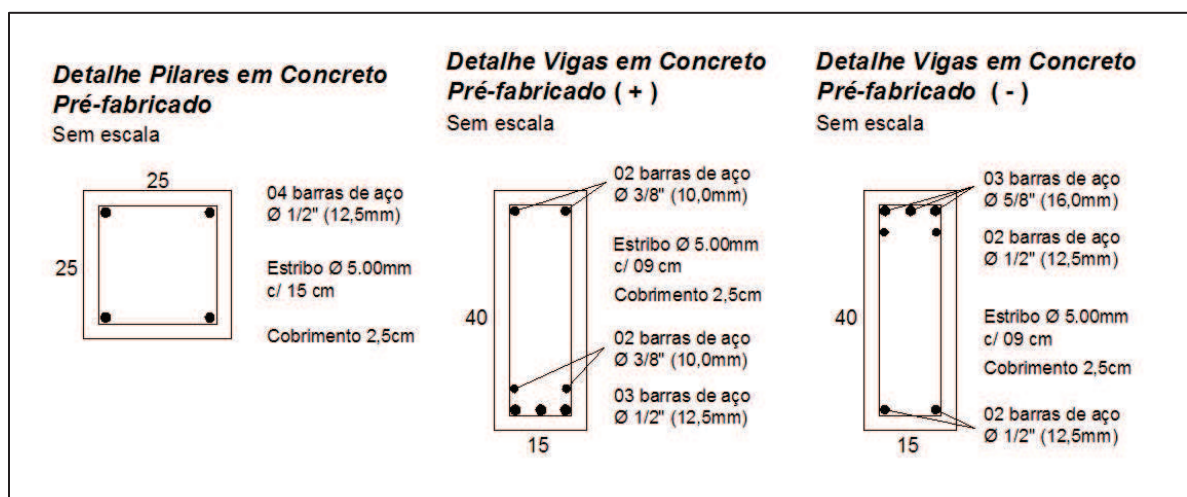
Detalhe seção vigas e pilares- Modelo IV.
